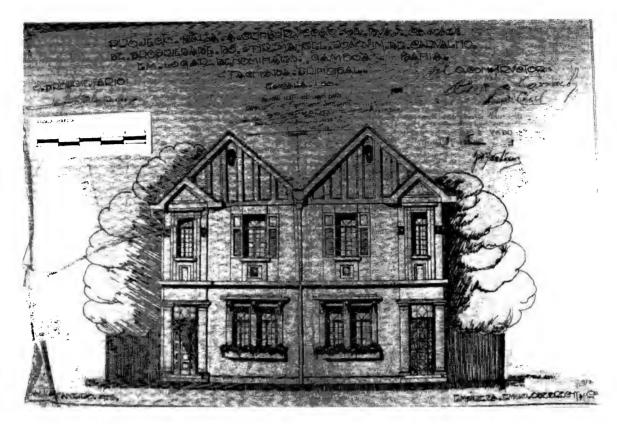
Projeto para a construção de duas casas à Gamboa, em 1928, sob a responsabilidade da Empresa Emílio Odebrecht. Fachada Principal.
